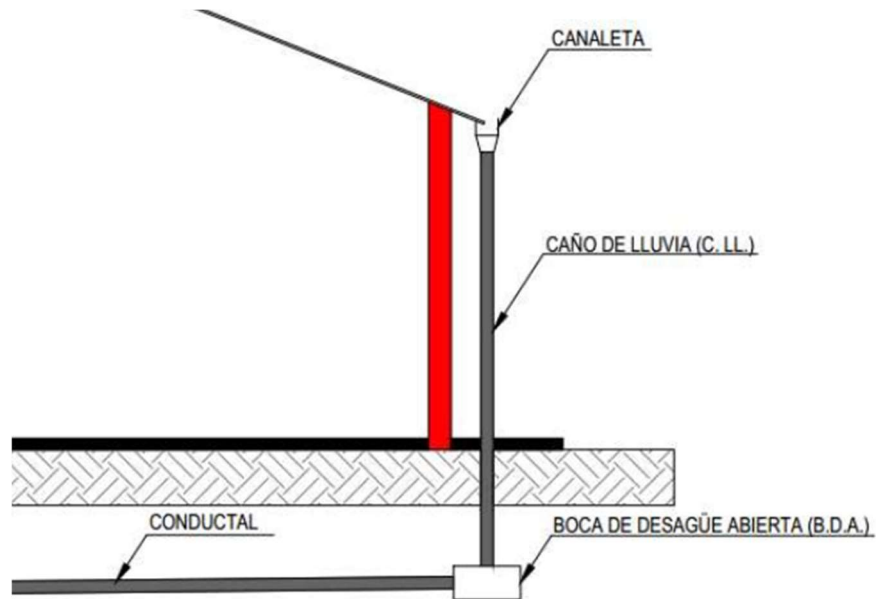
CORTE - INSTALACIÓN PLUVIAL TIPO.
